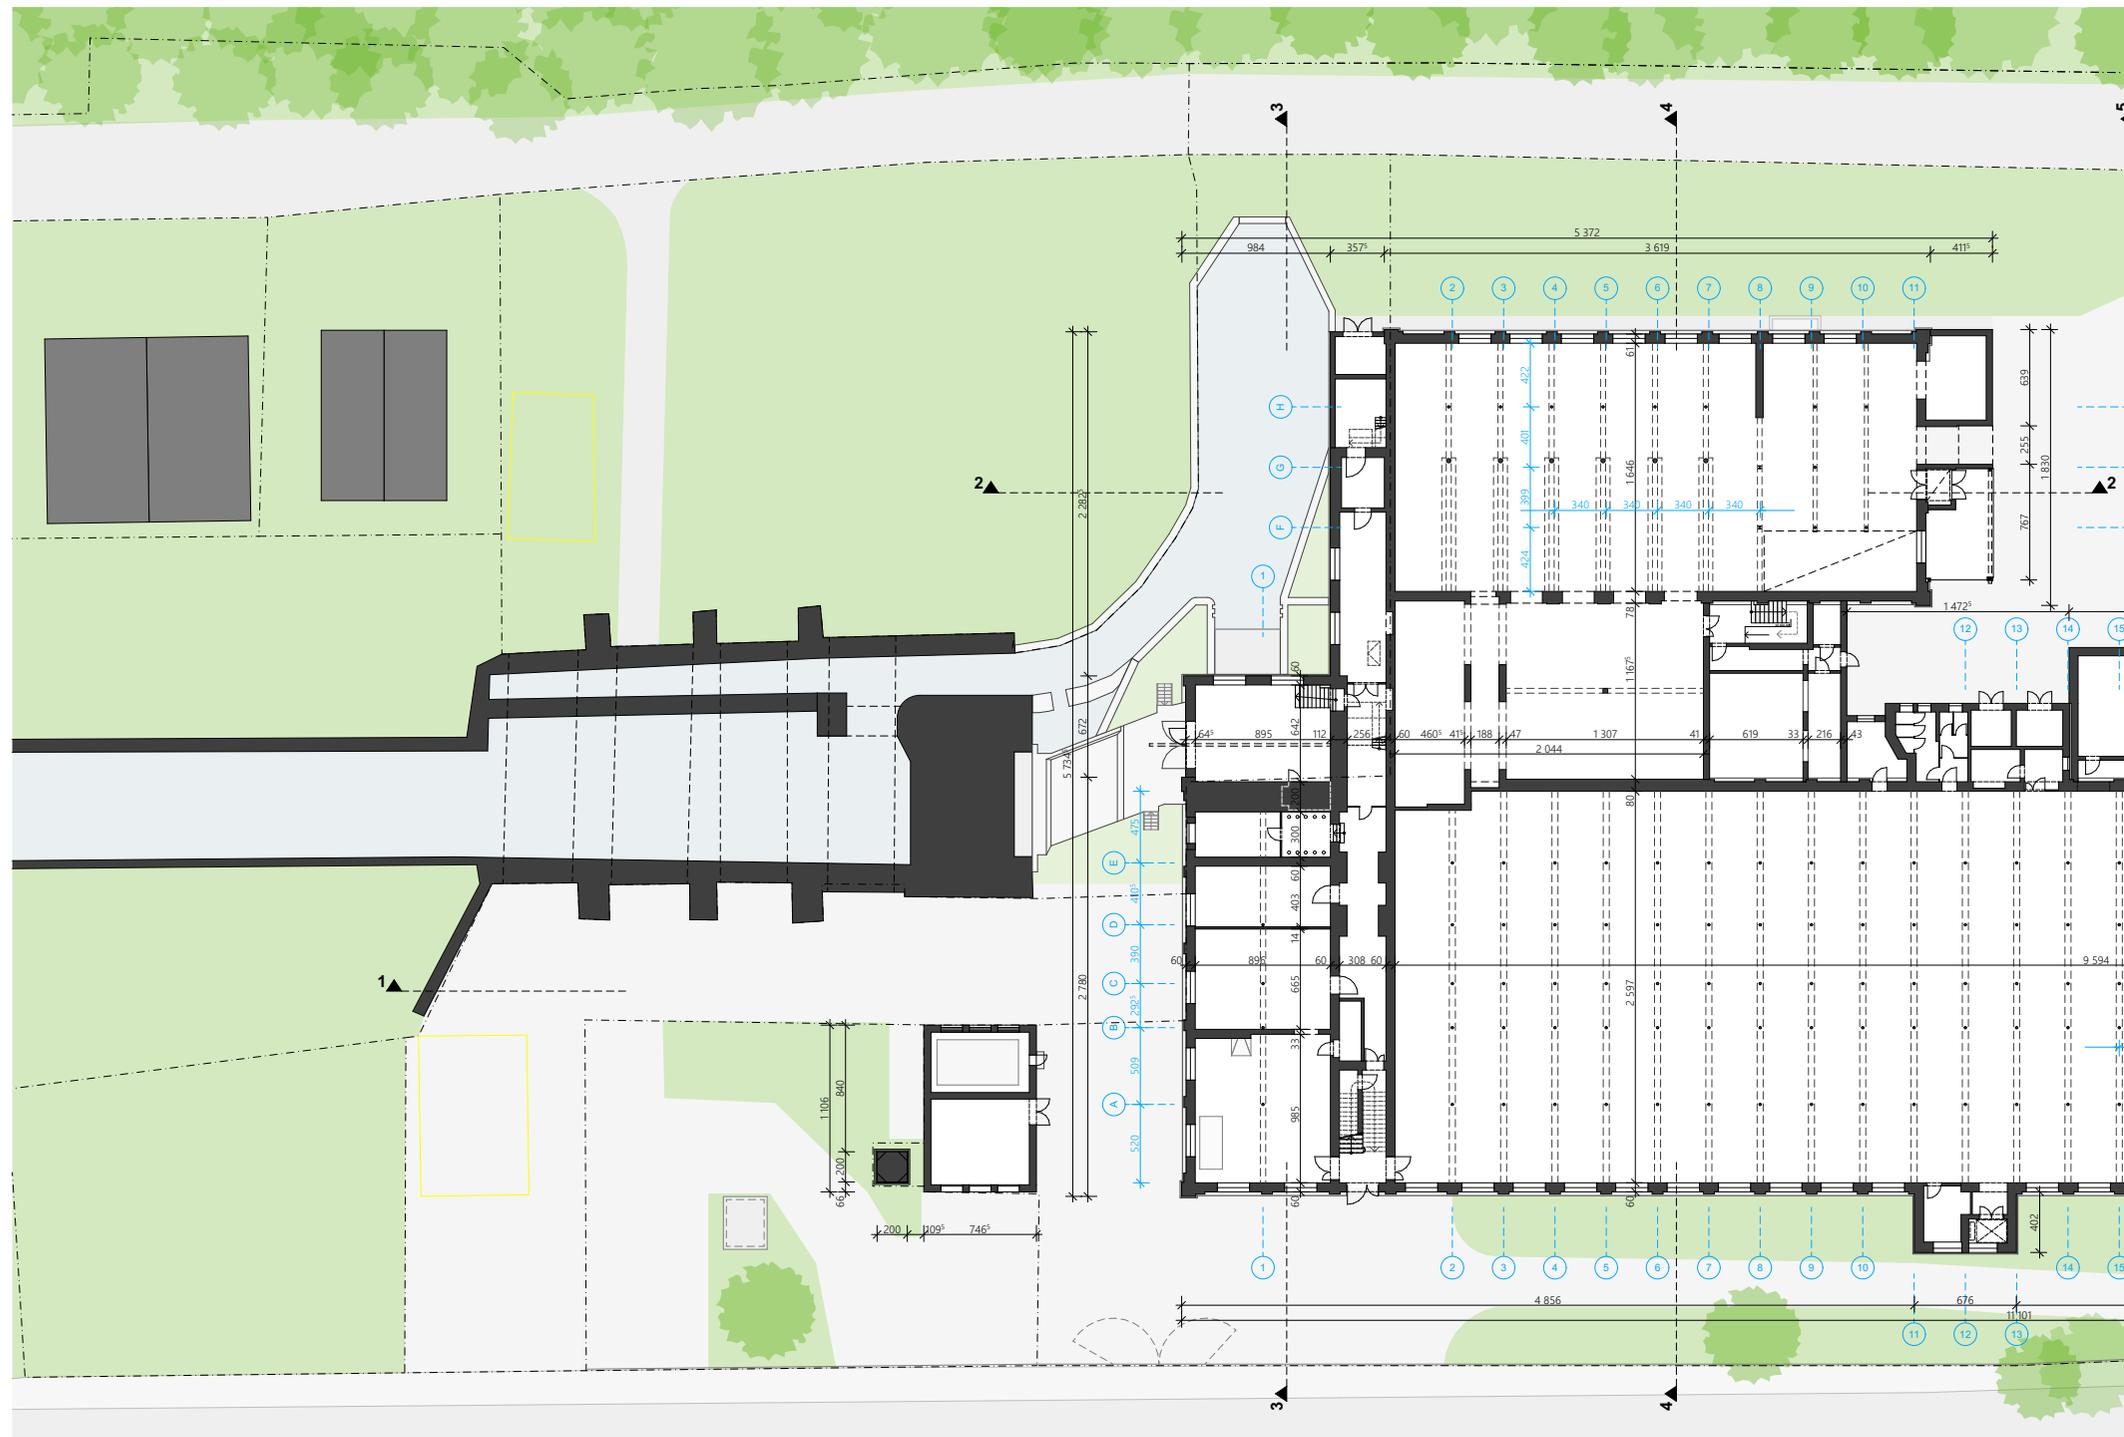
Grundriss Kellereschoß, M 1:500
